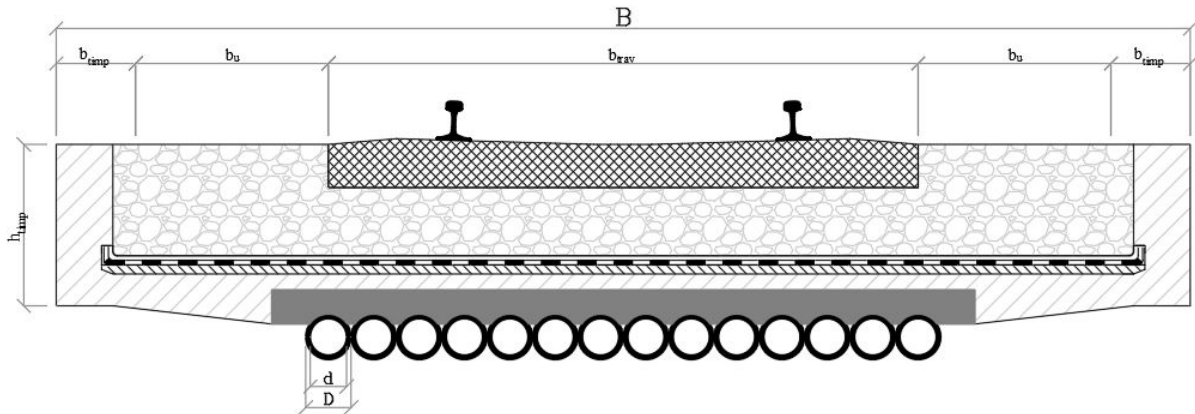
1 – Secțiune transversală dală cu secțiune mixtă oțel-beton – structura metalică din țevi alăturate
